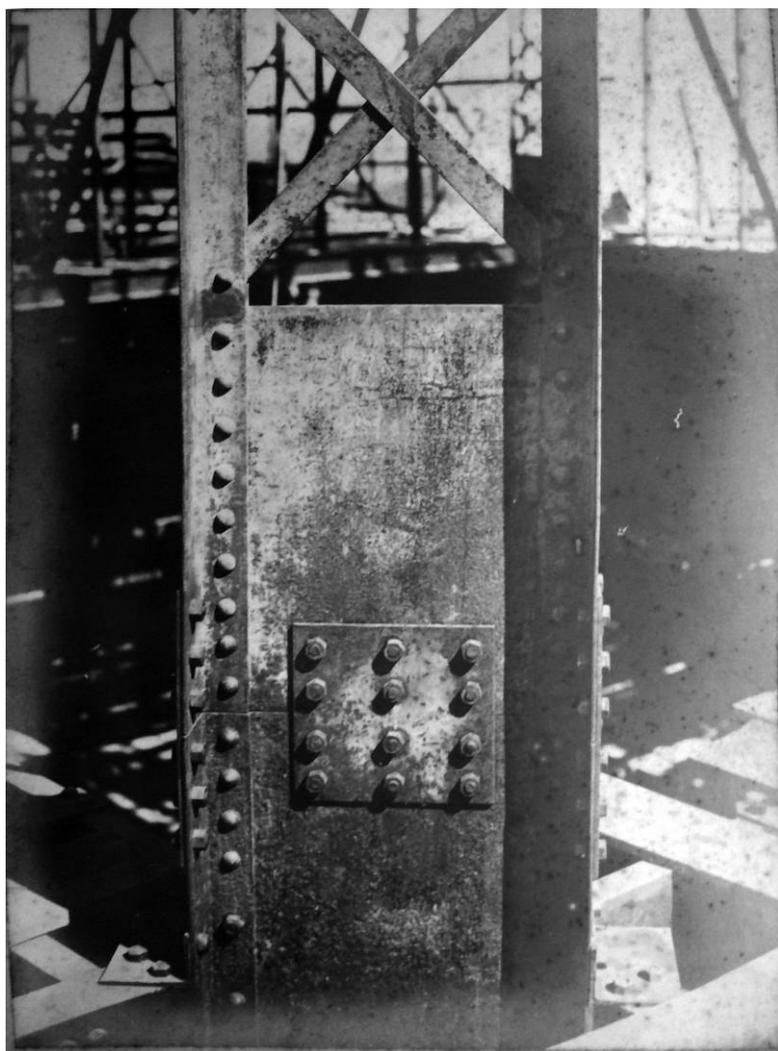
Fotografia de detalhe de uma coluna metálica da Biblioteca Nacional em meio a montagem (Álbum da Construção, sem data, cerca de 1906/1907. Seção de Iconografia – FBN).
